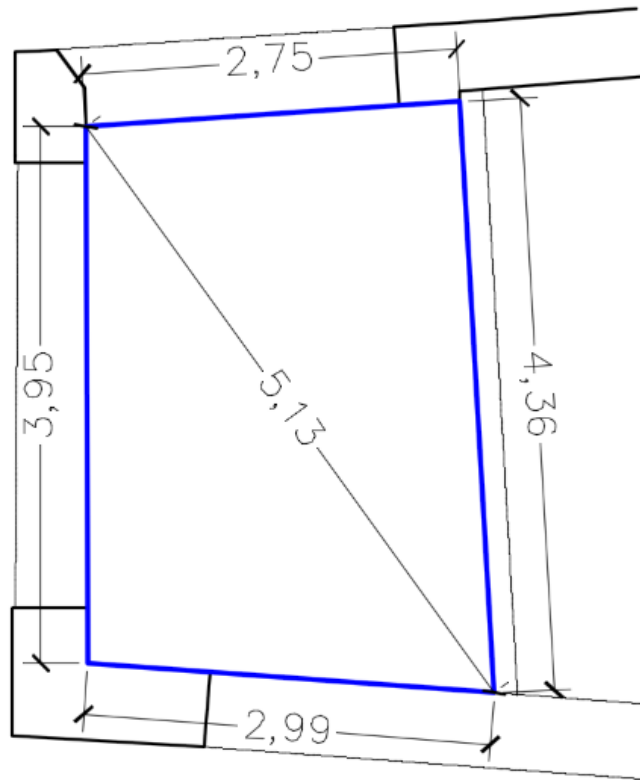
Dimensiones de zona 3 de forjado de planta 1ª.
